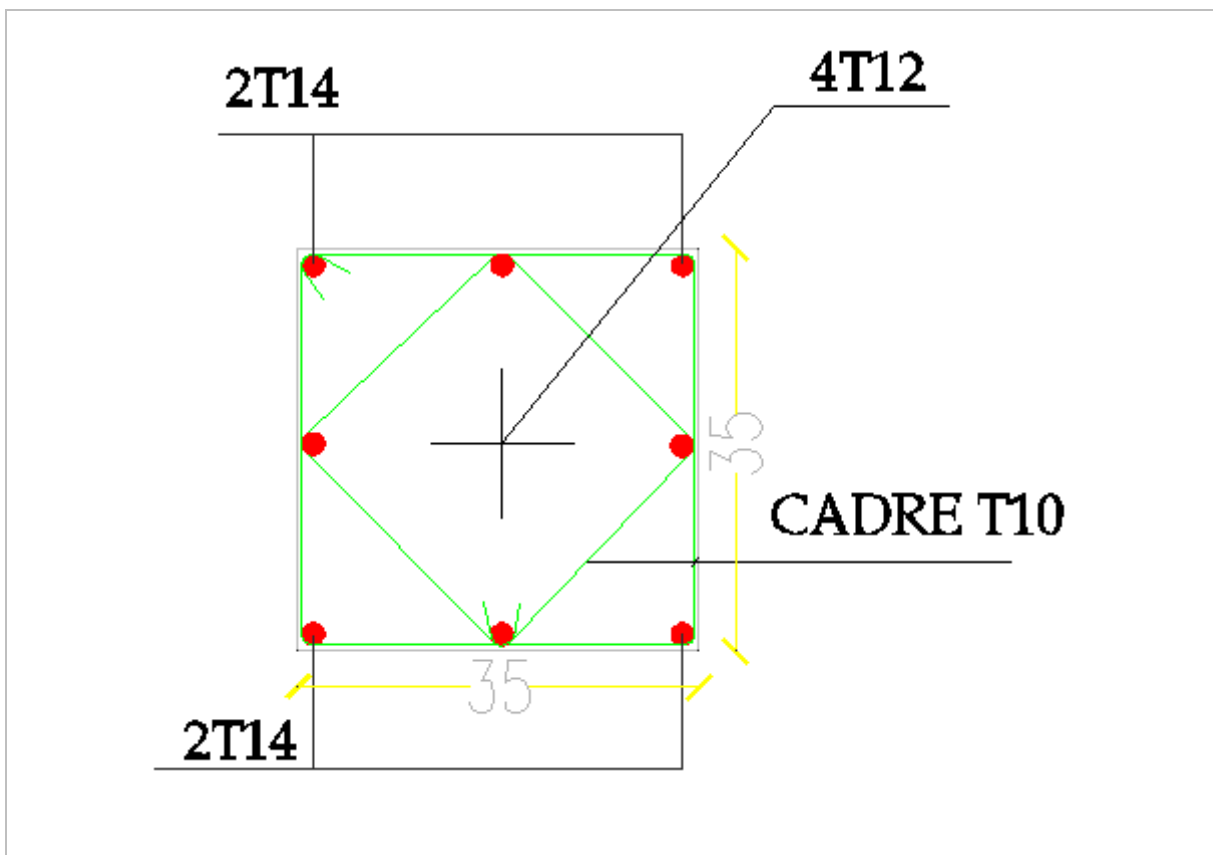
Ferrailage des poteaux carrés 35 x 35.
